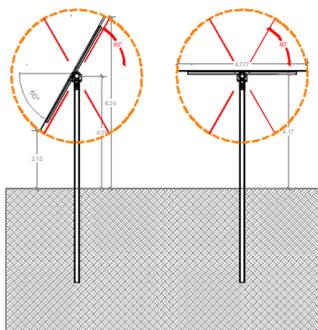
Stralcio progettuale: sezione tipo struttura porta pannelli
